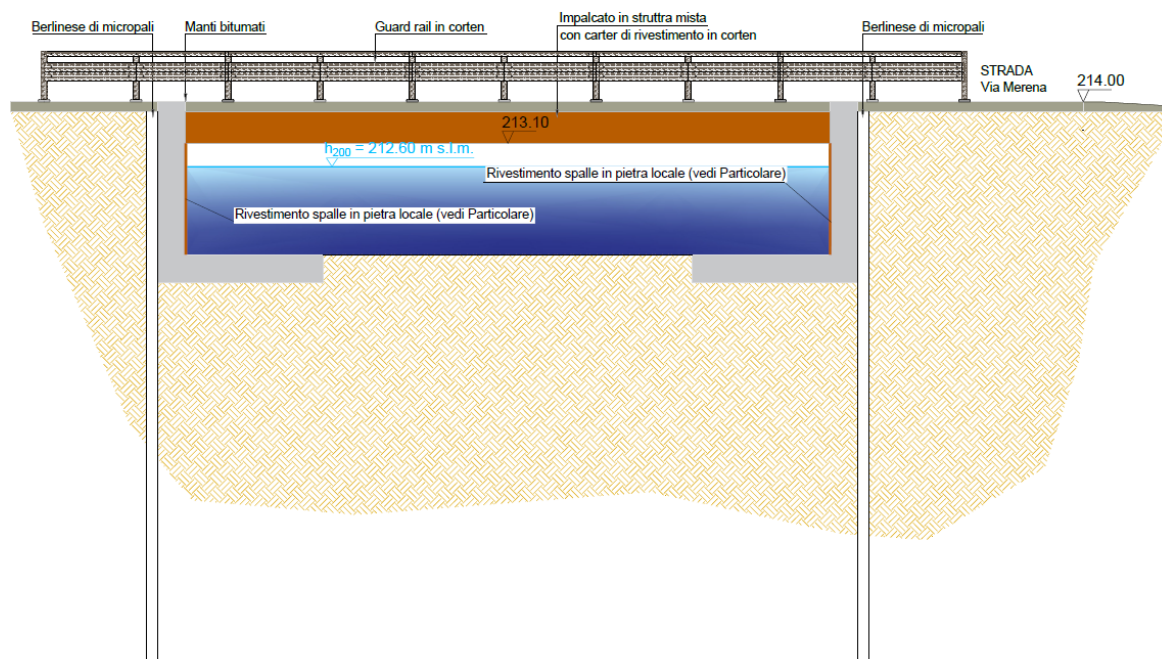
SEZIONE TIPOLOGICA DEL PONTE IN PROGETTO
